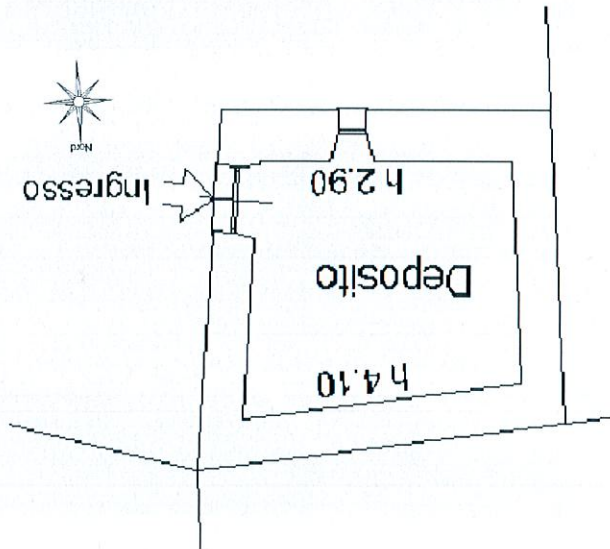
STRALCIO PLANIMETRICO DEL BENE INDAGATO.
